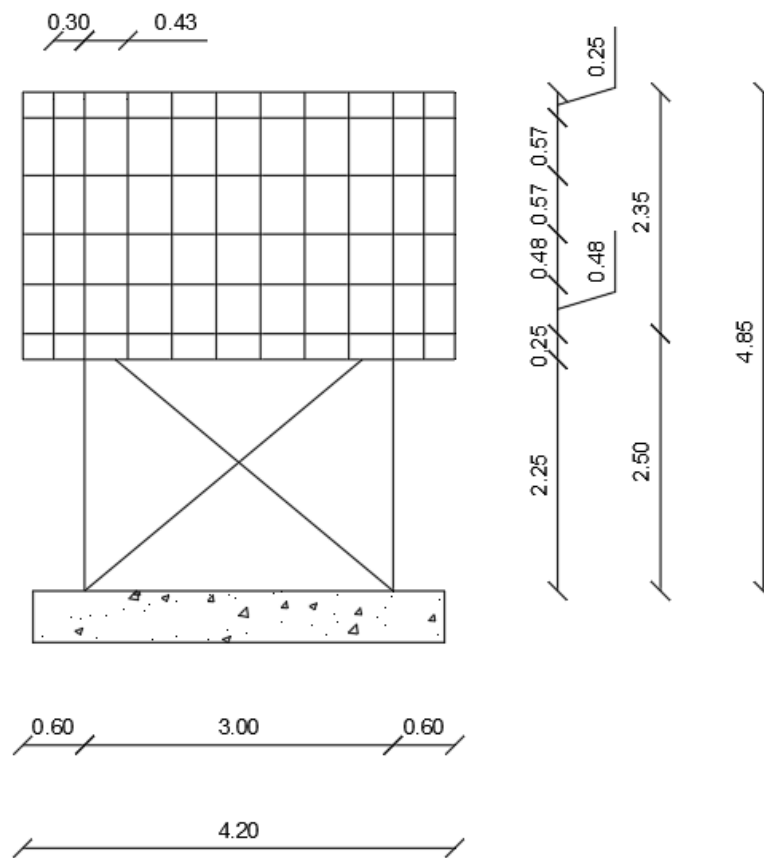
Prospetto Est dell'edificio a seguito delle modifiche.
